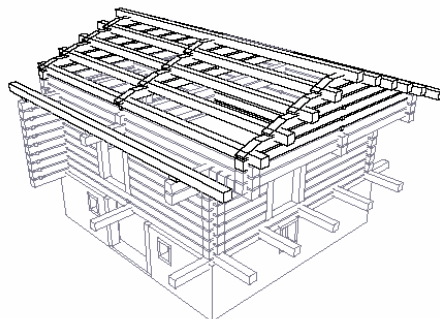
Tetto: “elemento” componente: travi disposte a “blockbau”
